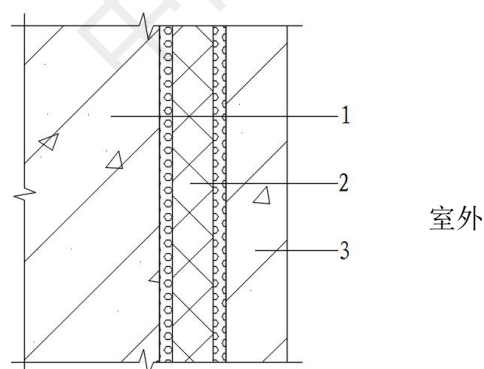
真空绝热复合保温预制混凝土夹心墙板基本构造
